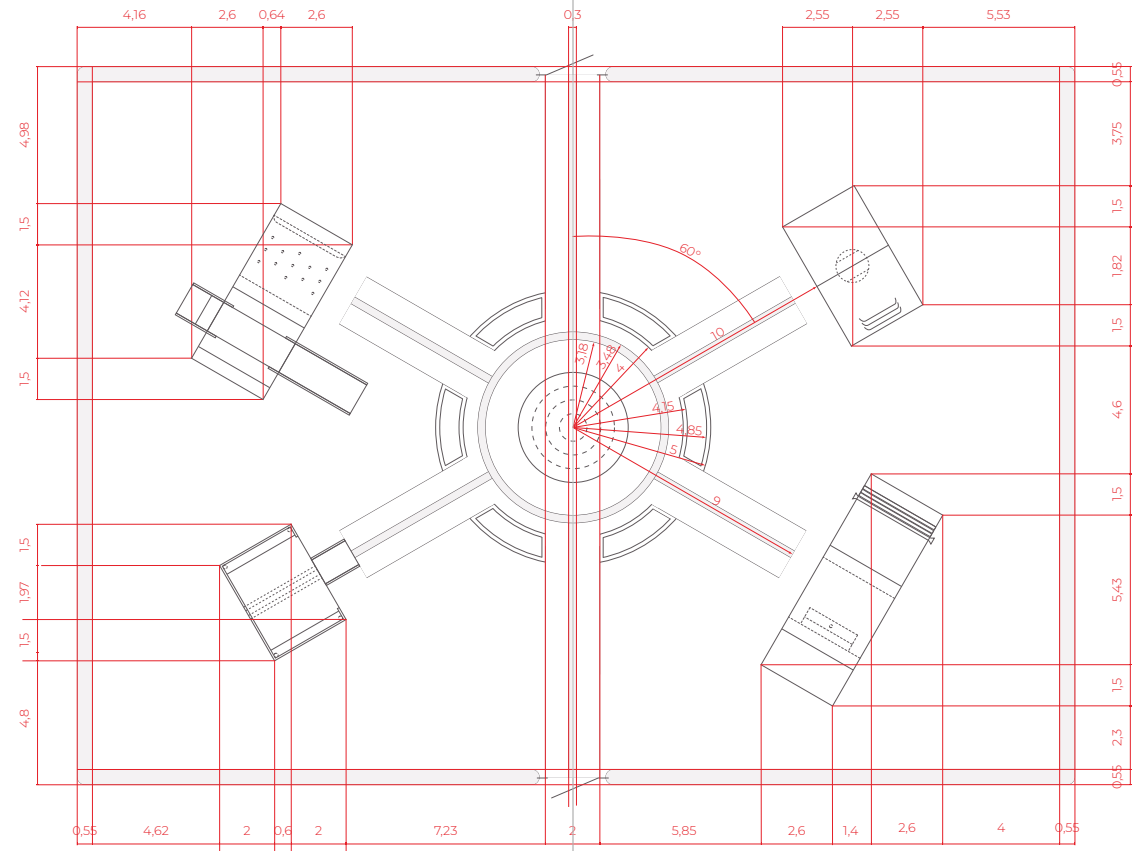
Dibujo Constructivo VI. Planta, elaboración propia.
